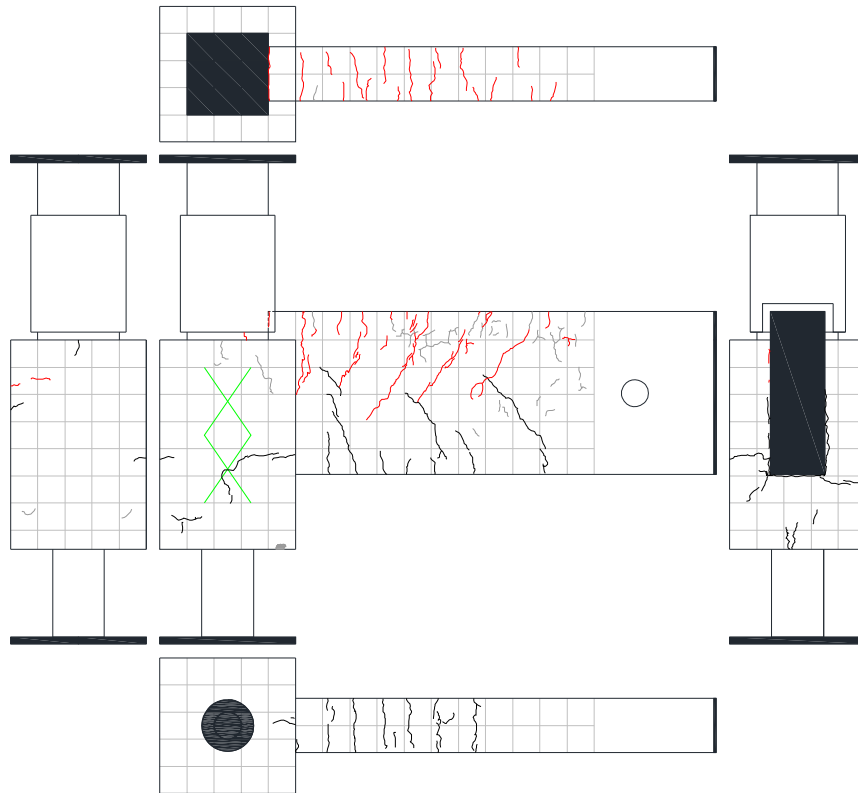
試験体 D-4 ひび割れ状況 (1Cycle)
